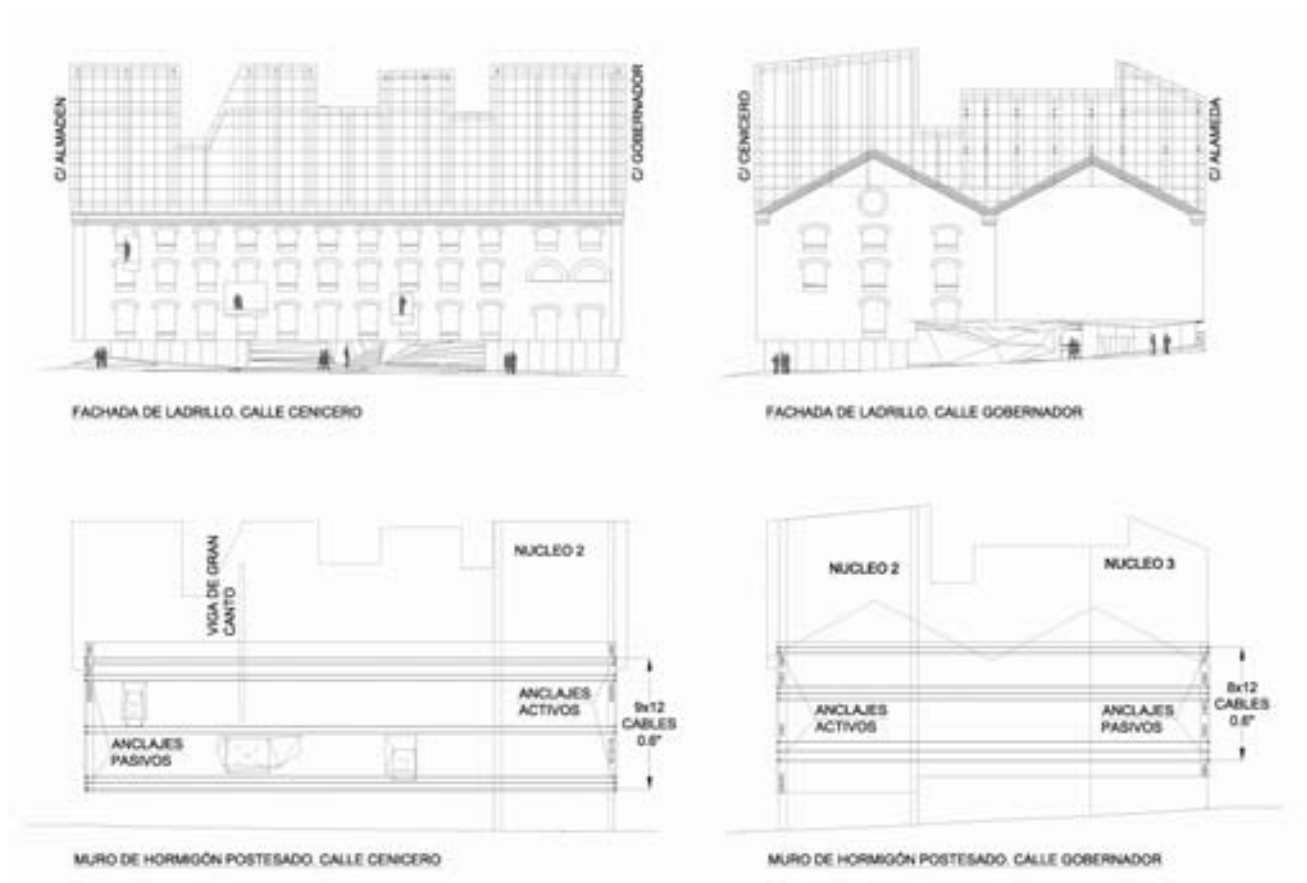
Muro perimetral. Solución con trazado recto horizontal de los cables.
